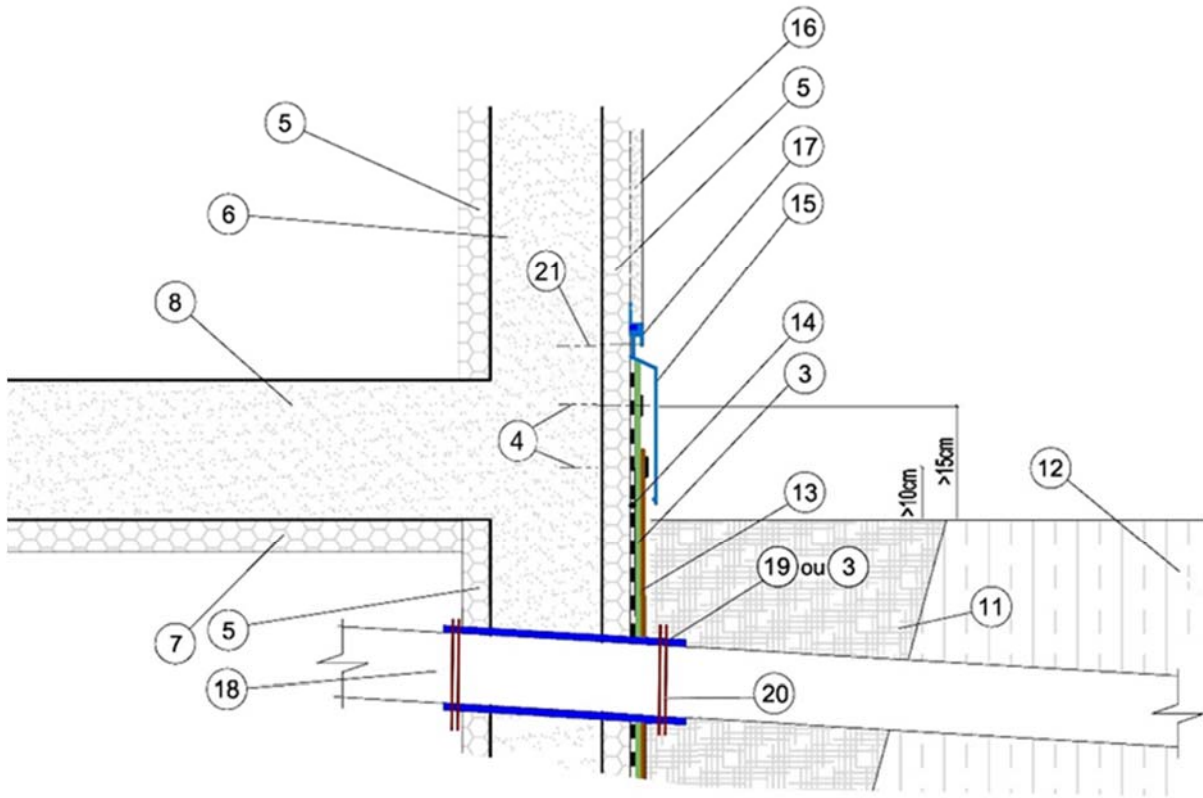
Traitement des traversées horizontales sur mur extérieur enterré
